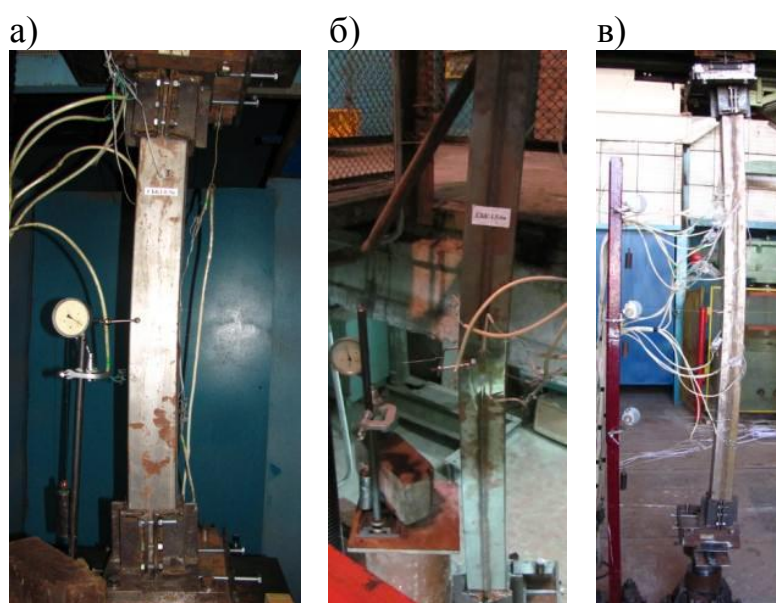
Зовнішній вигляд сталобетонних колон квадратного поперечного перерізу під час проведення випробувань: а - колона серії СБК-1.0-1, б - колона серії СБК-1.5-1, в - колона серії СБК-2.0-1.
